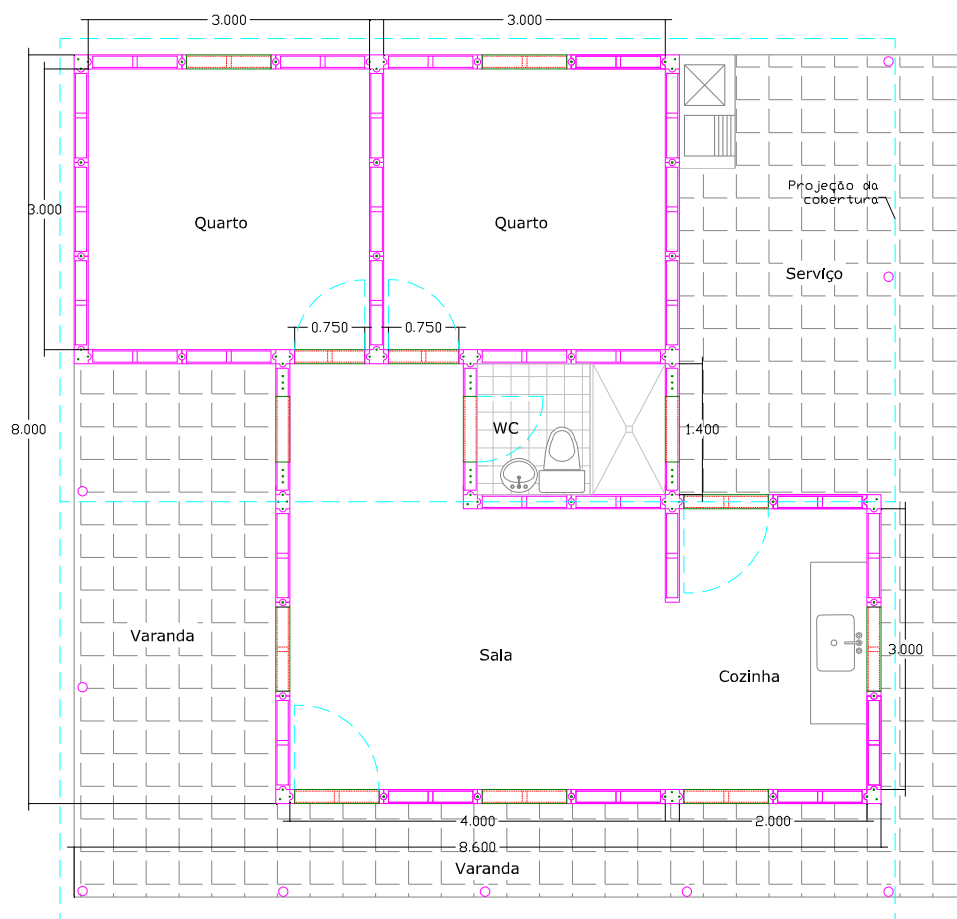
Planta baixa da residência com painéis para a primeira alternativa de sistema construtivo.
